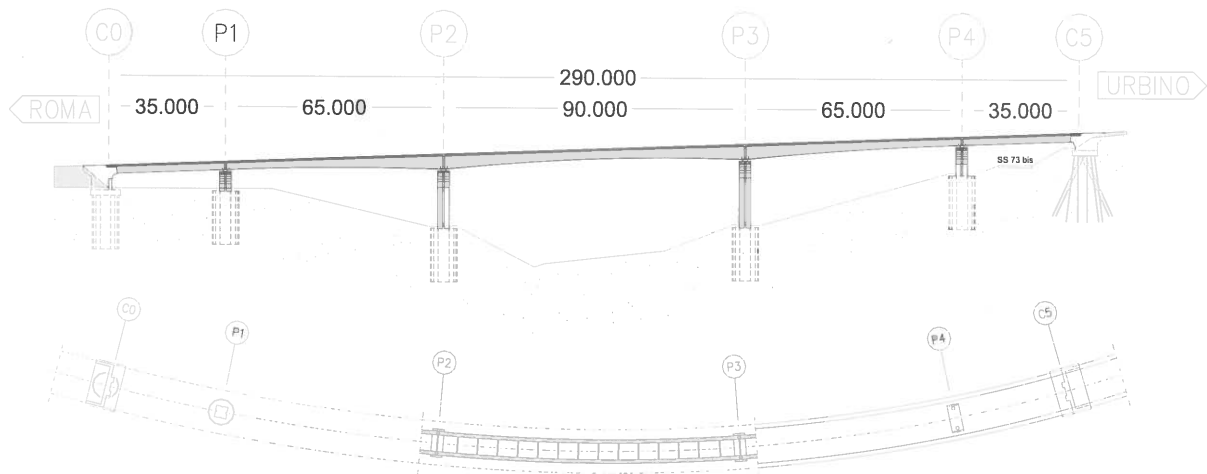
Viaduc Santa Maria : élévation et vue en plan / Elevation and plan view
